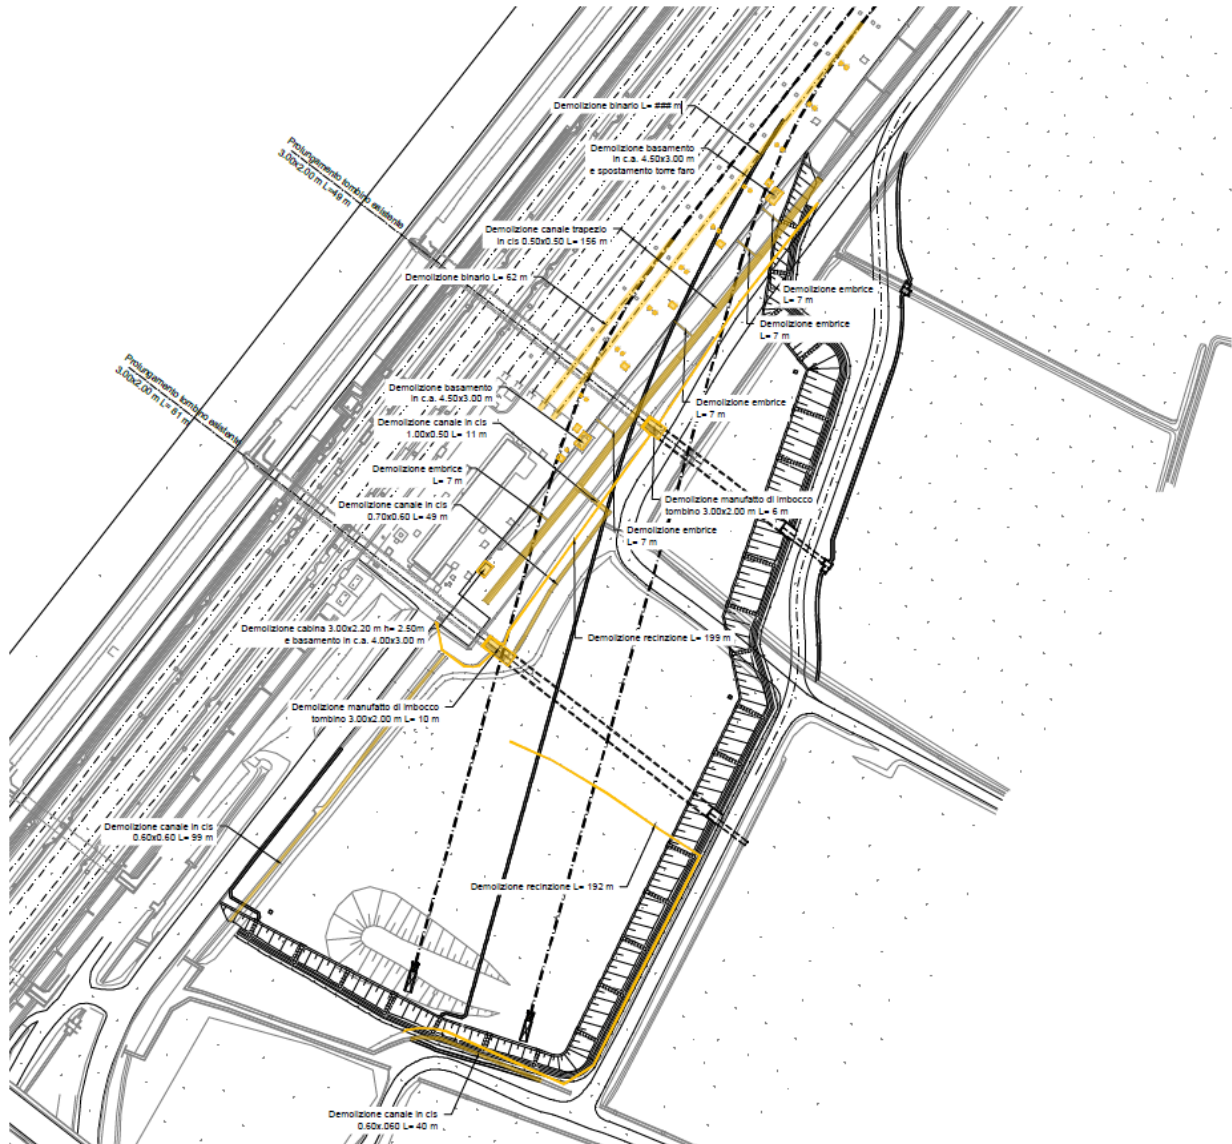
Stralcio planimetria delle demolizioni (ALL_04)
